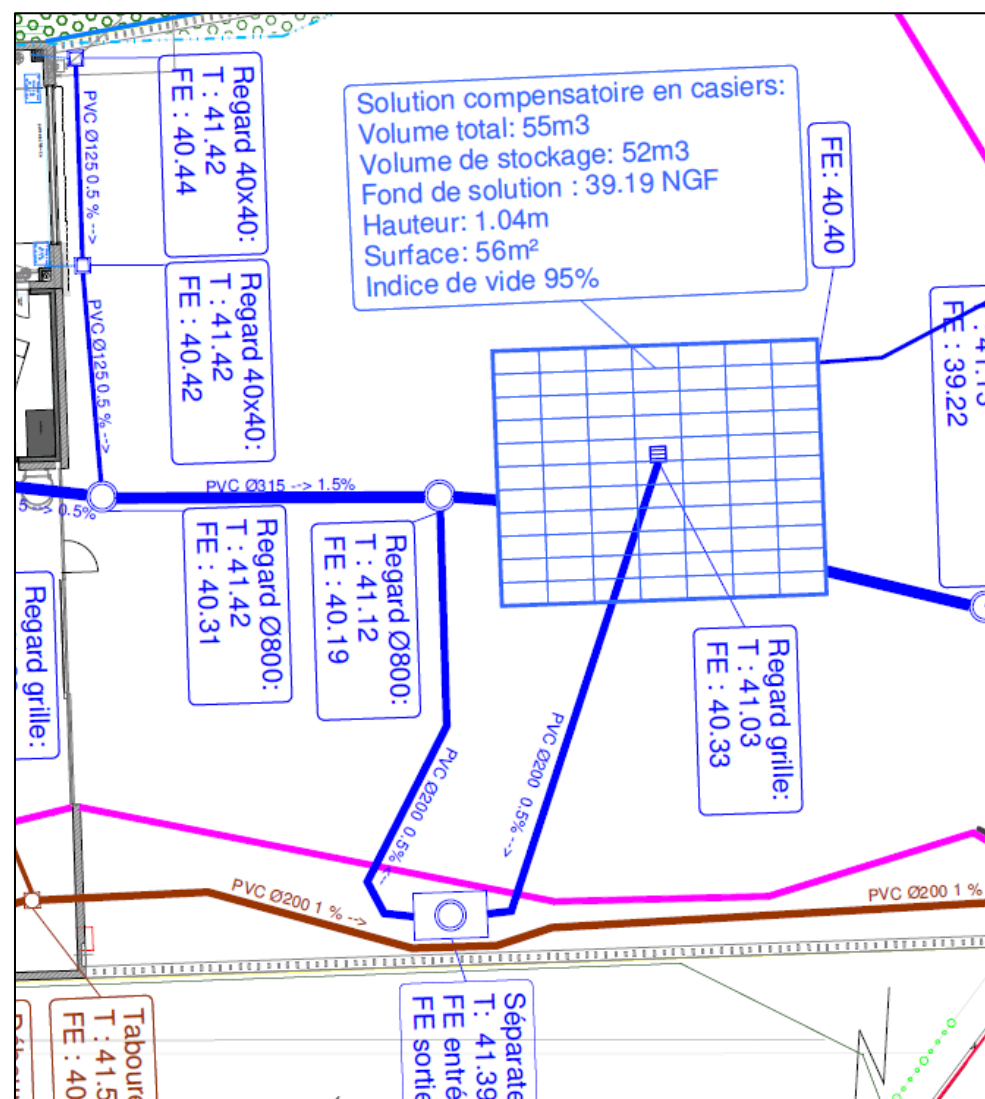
Extrait du plan d'assainissement de la chaufferie centrale du RCU (Source : SARL LTP, mai 2023)
